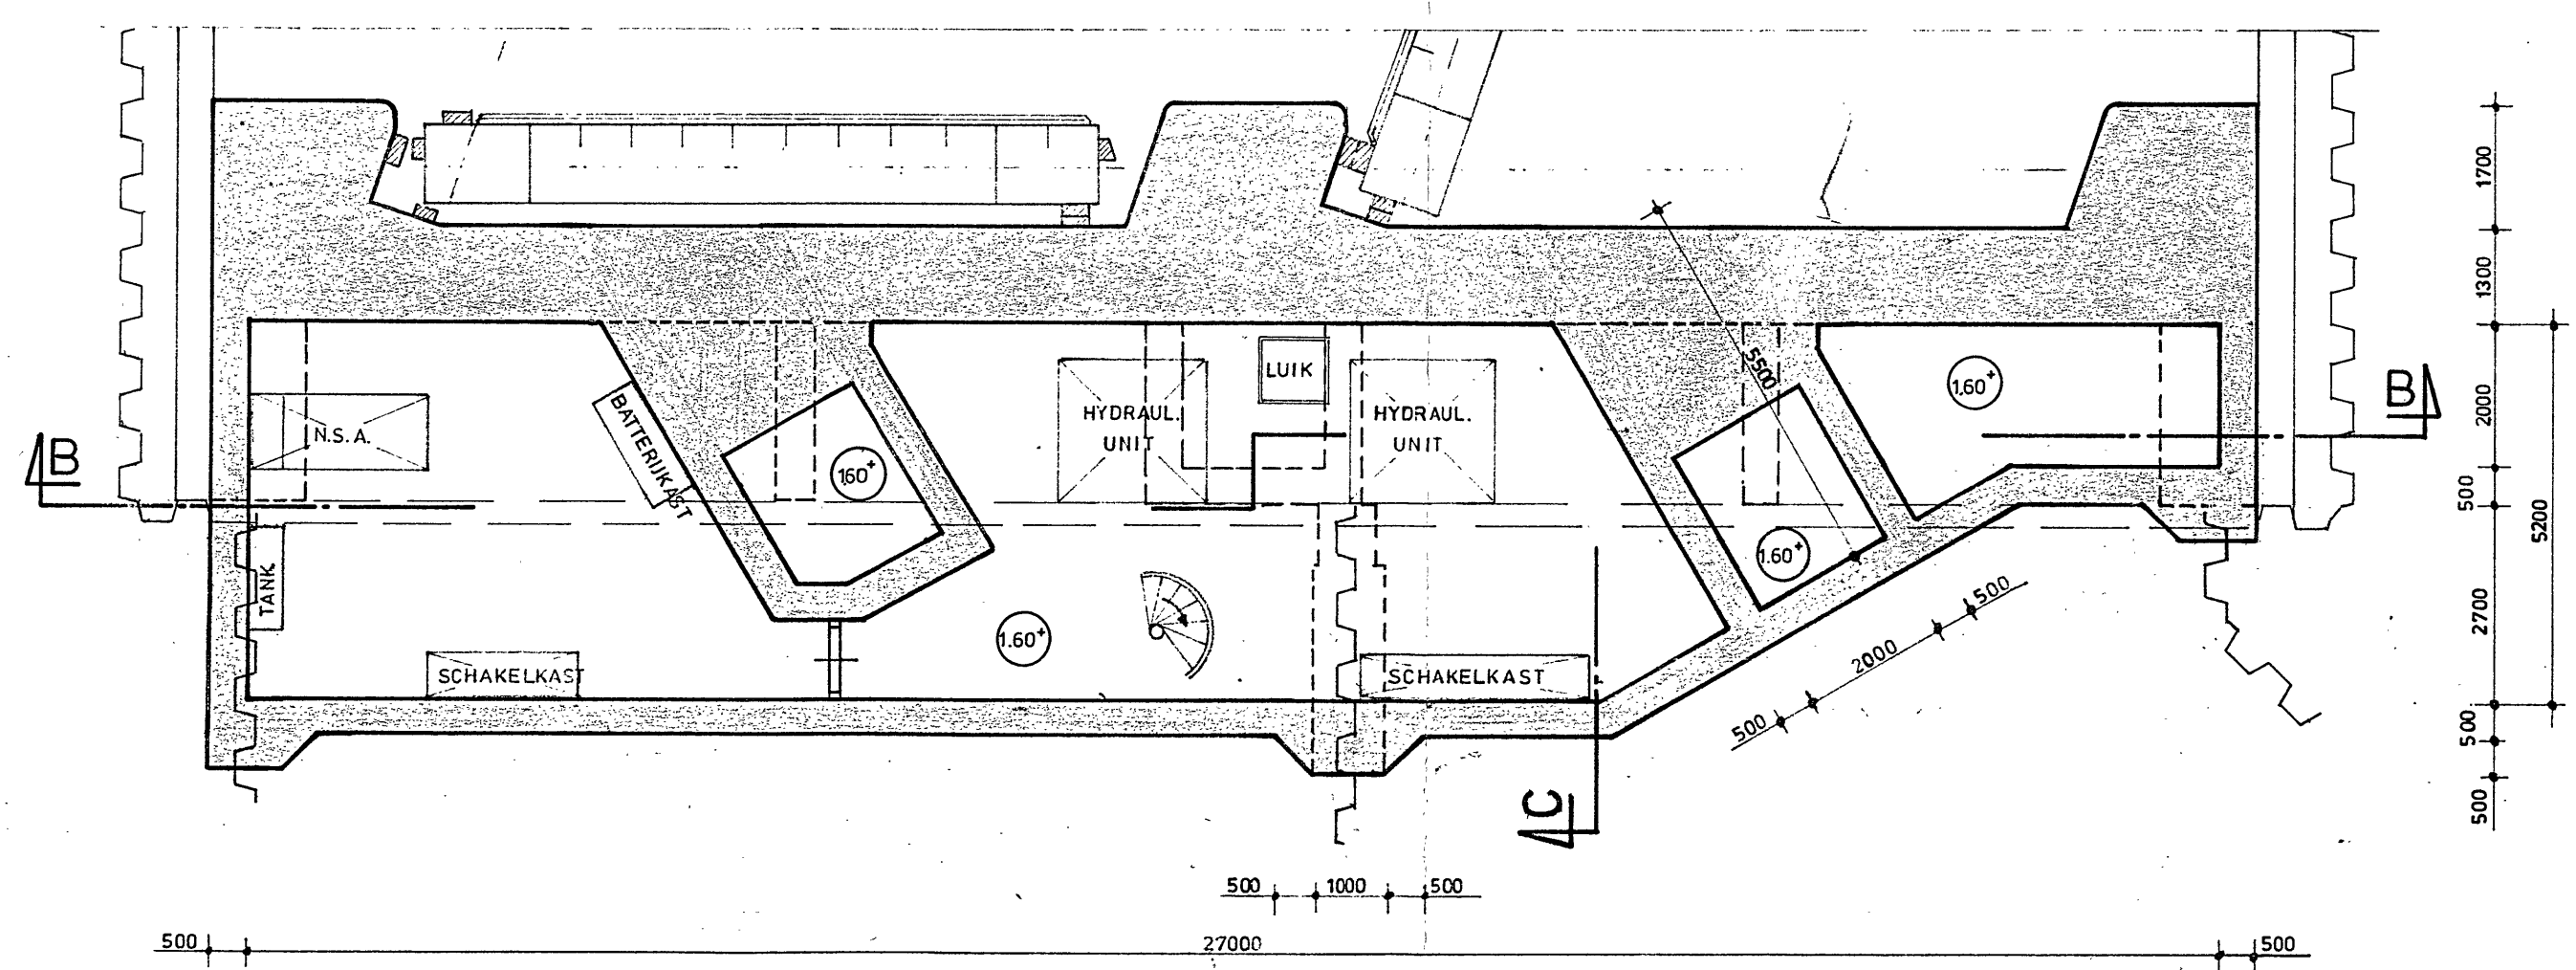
DETAIL BEEINDIGING SLUISVLOER (SCHAAK 1:50)
